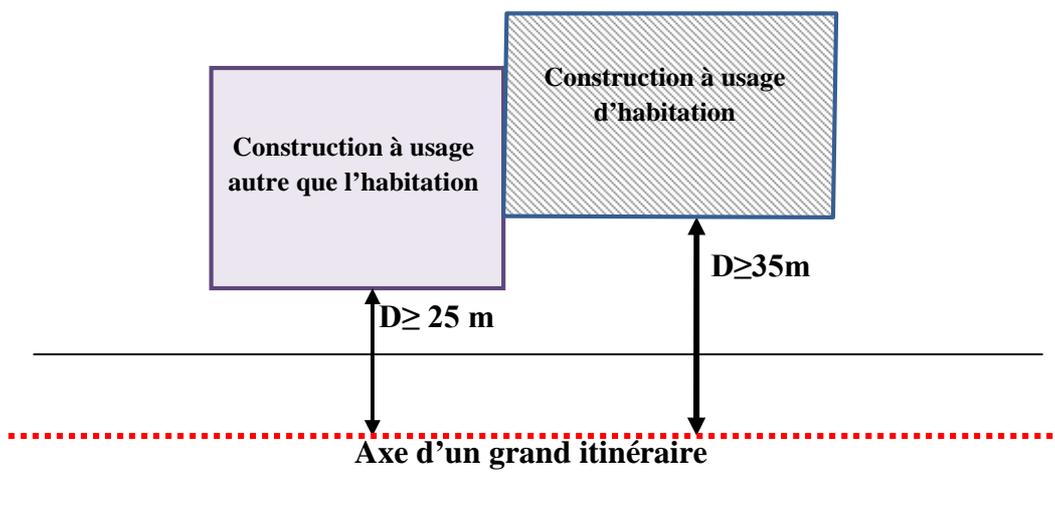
Vue en Plan définissant le recul ou la servitude d'une construction par rapport à un grand itinéraire
